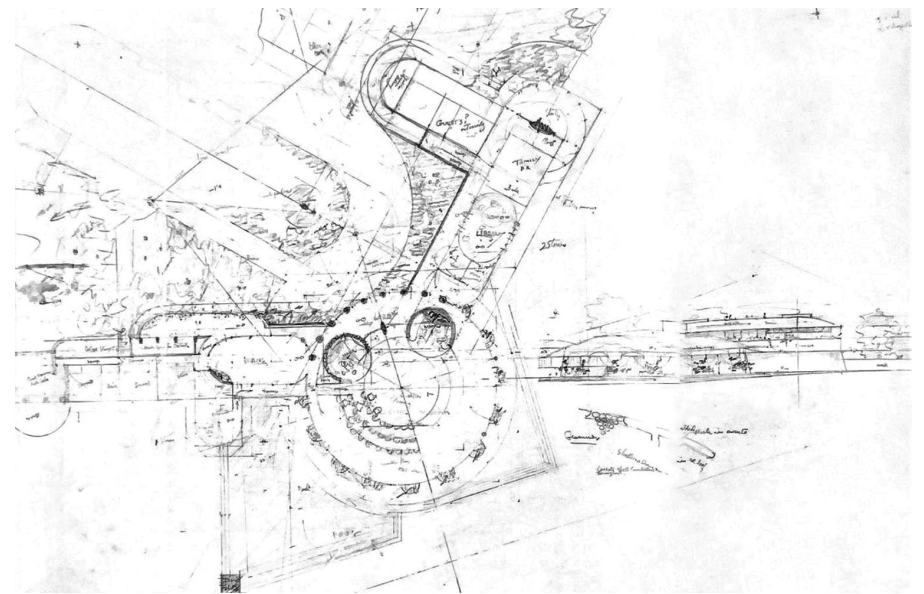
Frank Lloyd Wright. Boceto de planta baja y alzado. Casa "Crownfield". Fort Worth, Texas. Proyecto 1949.
